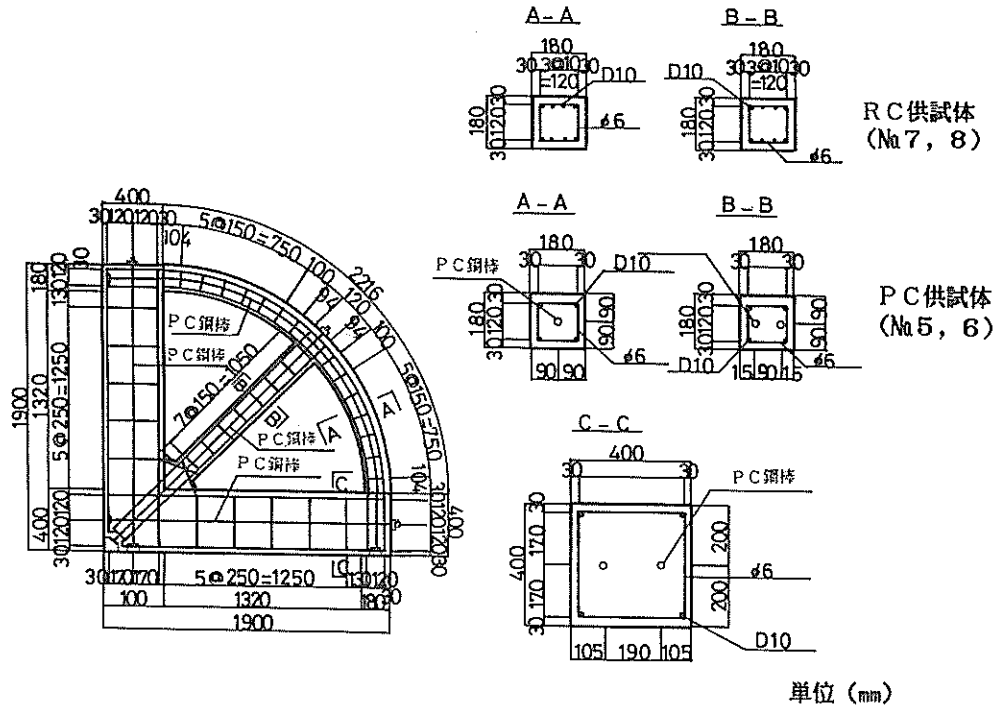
1/4円形供試体 (No. 5 ~ 8) の配筋図
